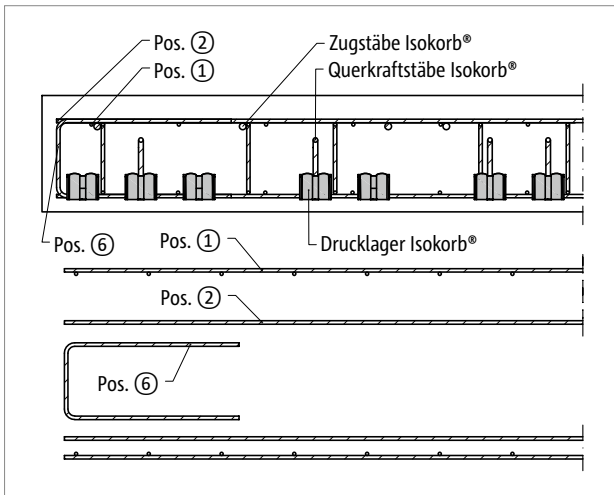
Schöck Isokorb® RT Typ K: Bauseitige Bewehrung balkonseitig im Schnitt A-A; Pos. 6 = konstruktive Randeinfassung am freien Rand
